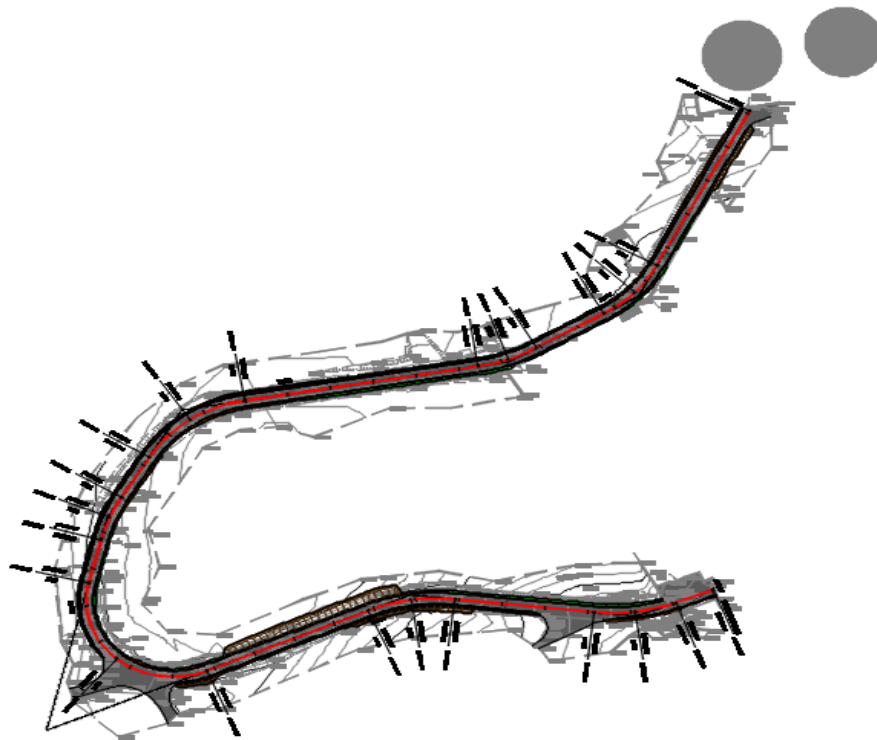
Traçado em Planta – Acesso ao Reservatório de Cerite
